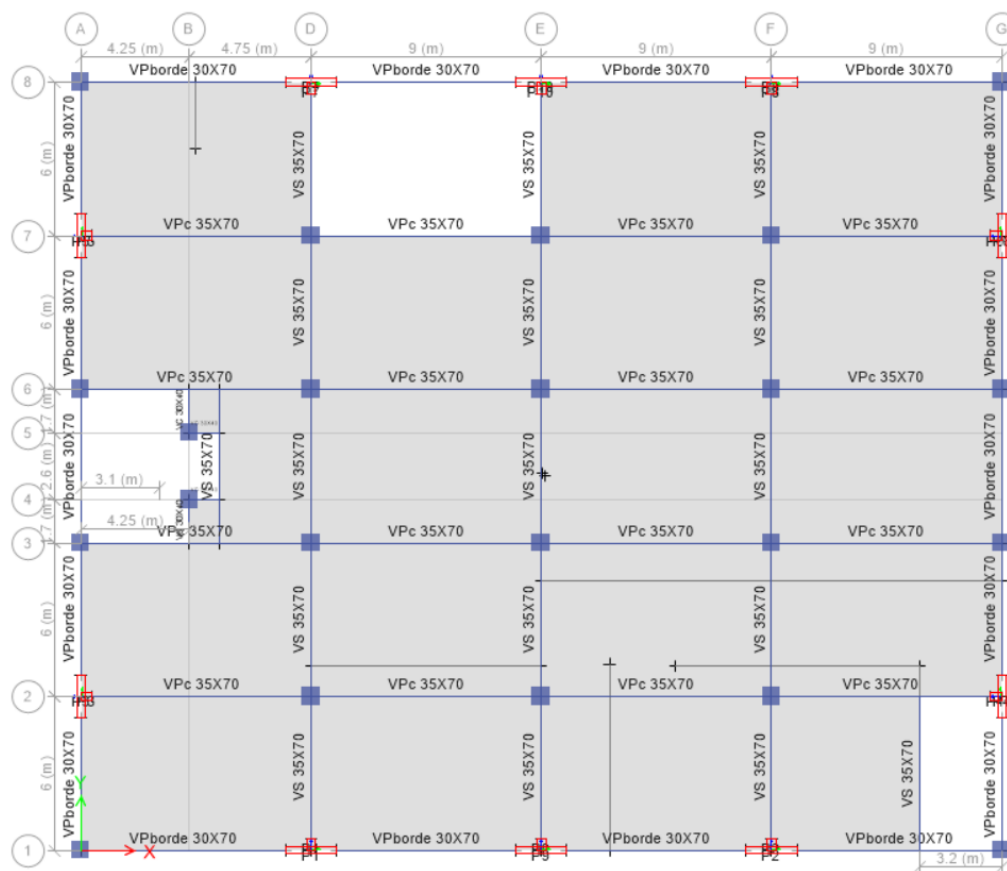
Vista en planta de la edificación empotrada. (Fuente Propia).
